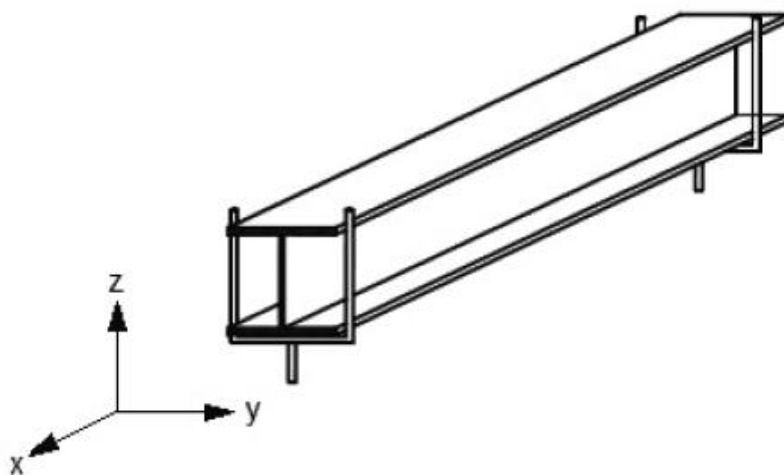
Condições de apoio e coluna-viga do tipo “forquilha” (Mendonça, 2006).
